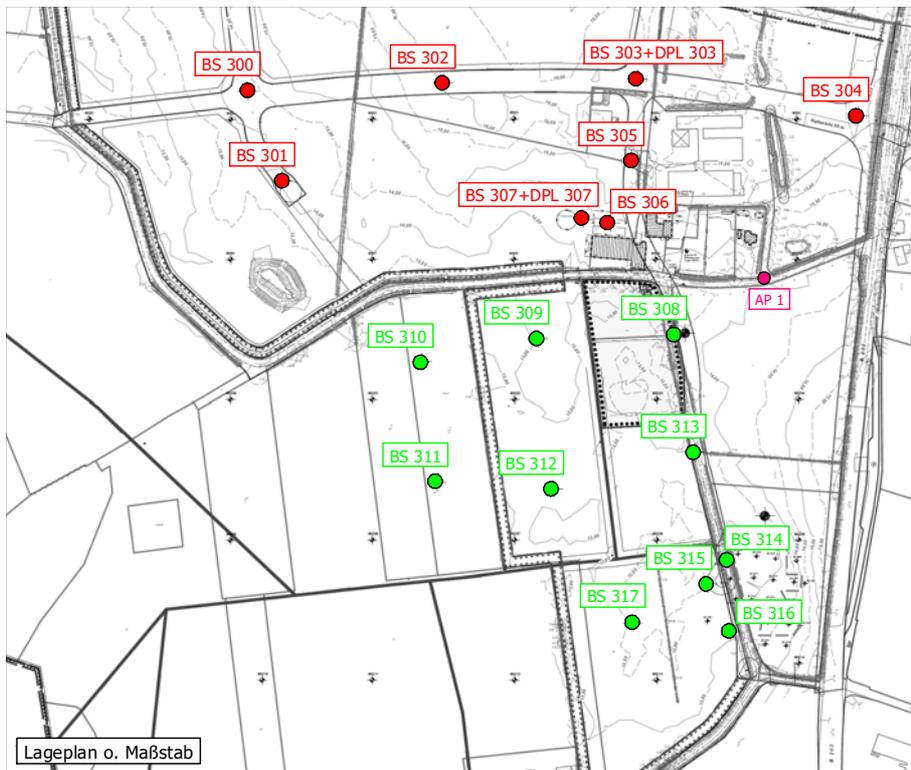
Lageplanausschnitt s. Anl. 1.22 (o. M.)
